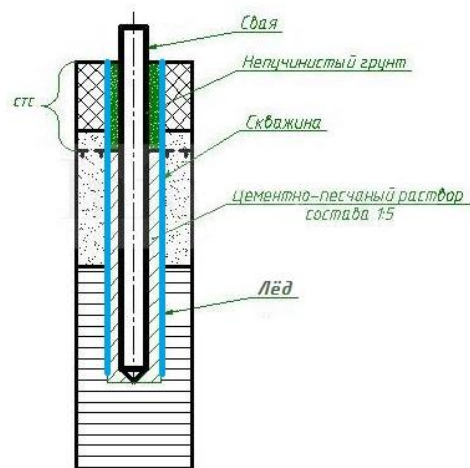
Буропускная свая со льдом между раствором и грунтом
